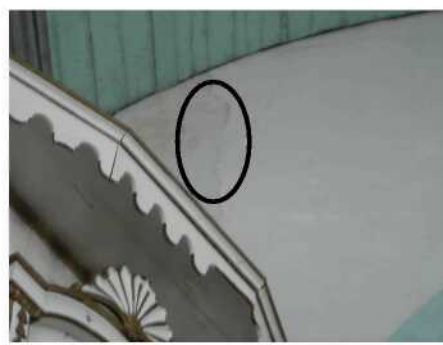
Fissura vertical junto ao arco cruzeiro. Foto da autora. 2005.
